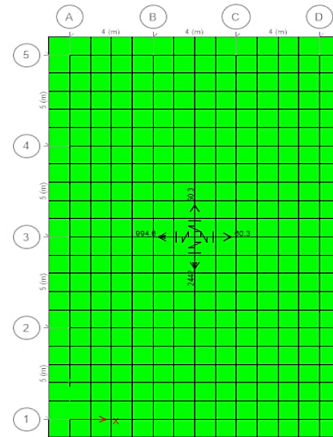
Vista modelo de losa de cimentación para edificio de 10, 15 y 20 pisos
